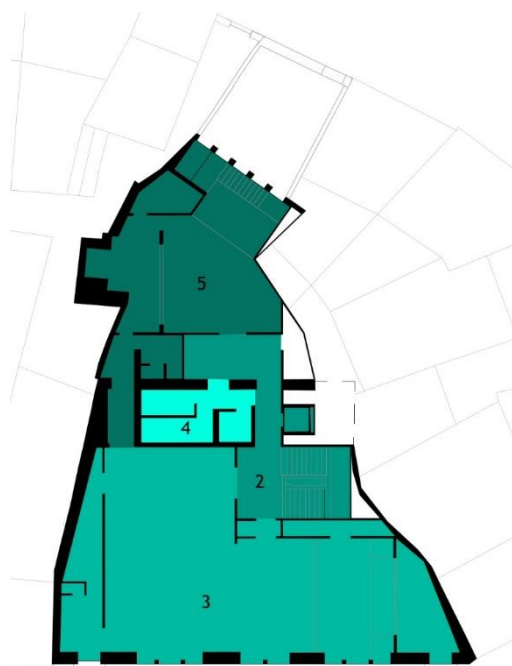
Caracterização de espaços da planta de projeto para o piso 1
